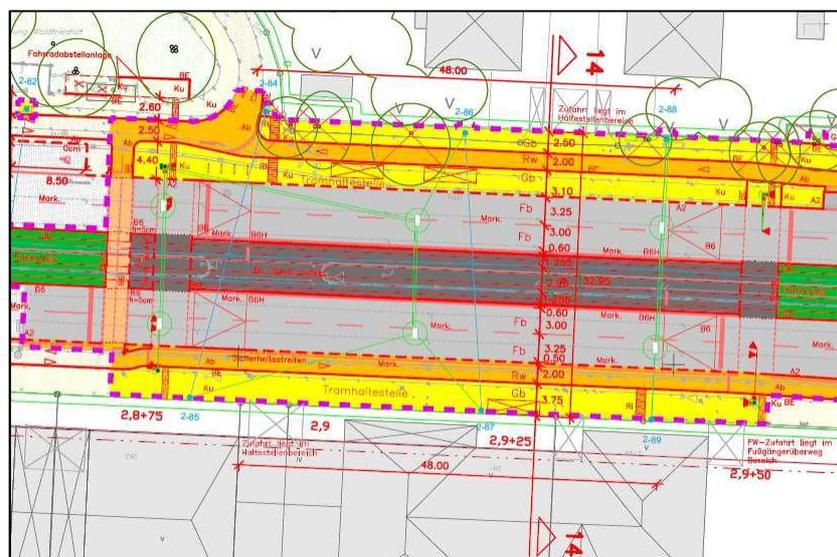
Lageplan Haltestelle Waldfriedhof Haupteingang, Auszug aus Unterlage 3.8
